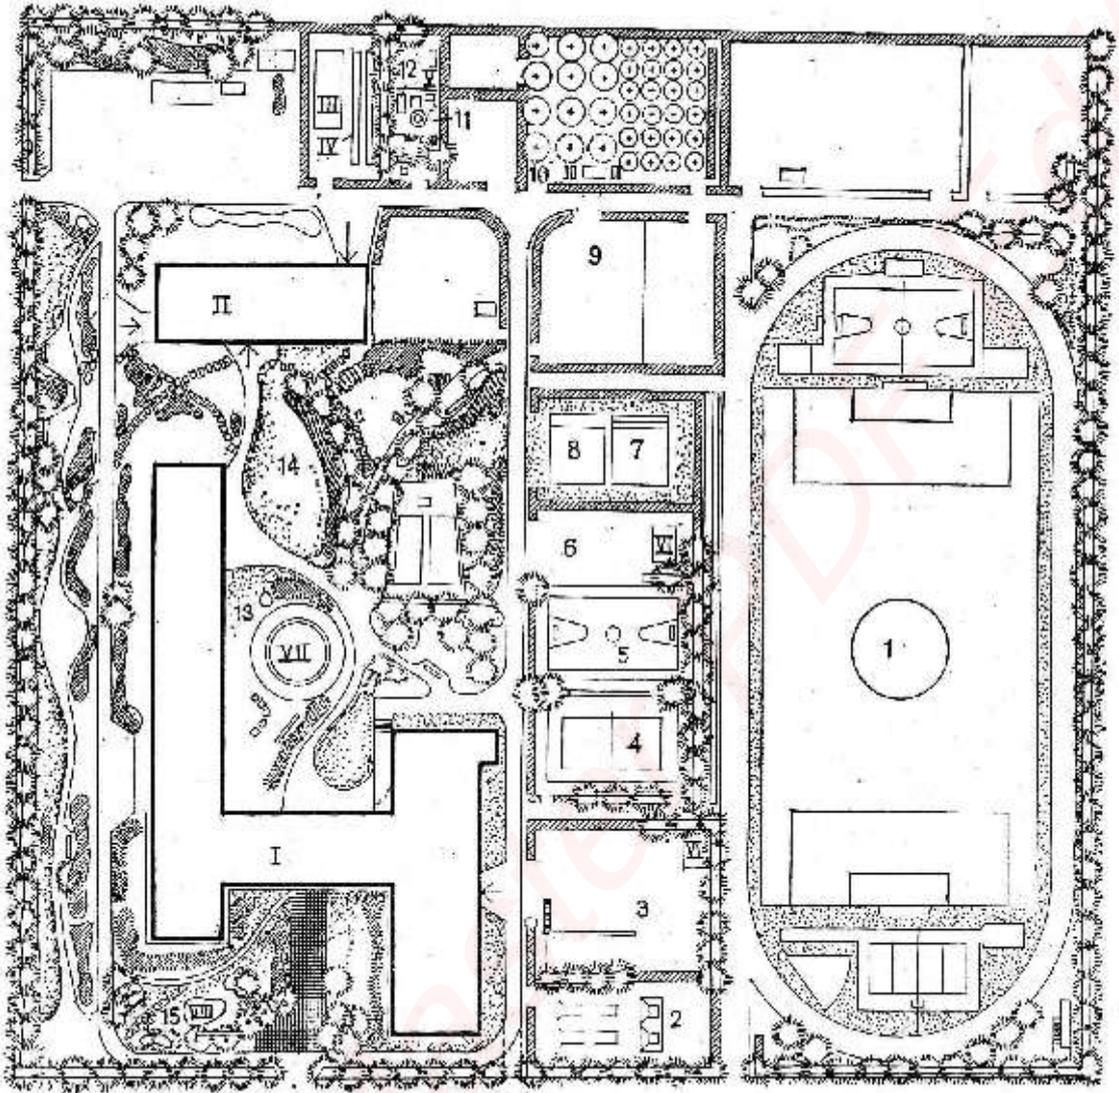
Схема генерального плана общеобразовательной школы на 960 учащихся:
